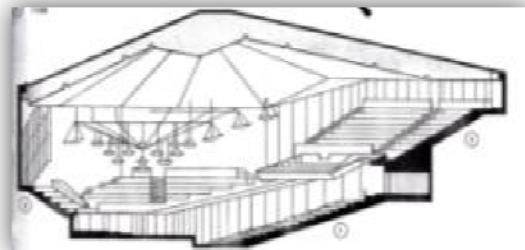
Corte. Sin escala. Fuente: Concert halls and opera houses. Beranek, L.
